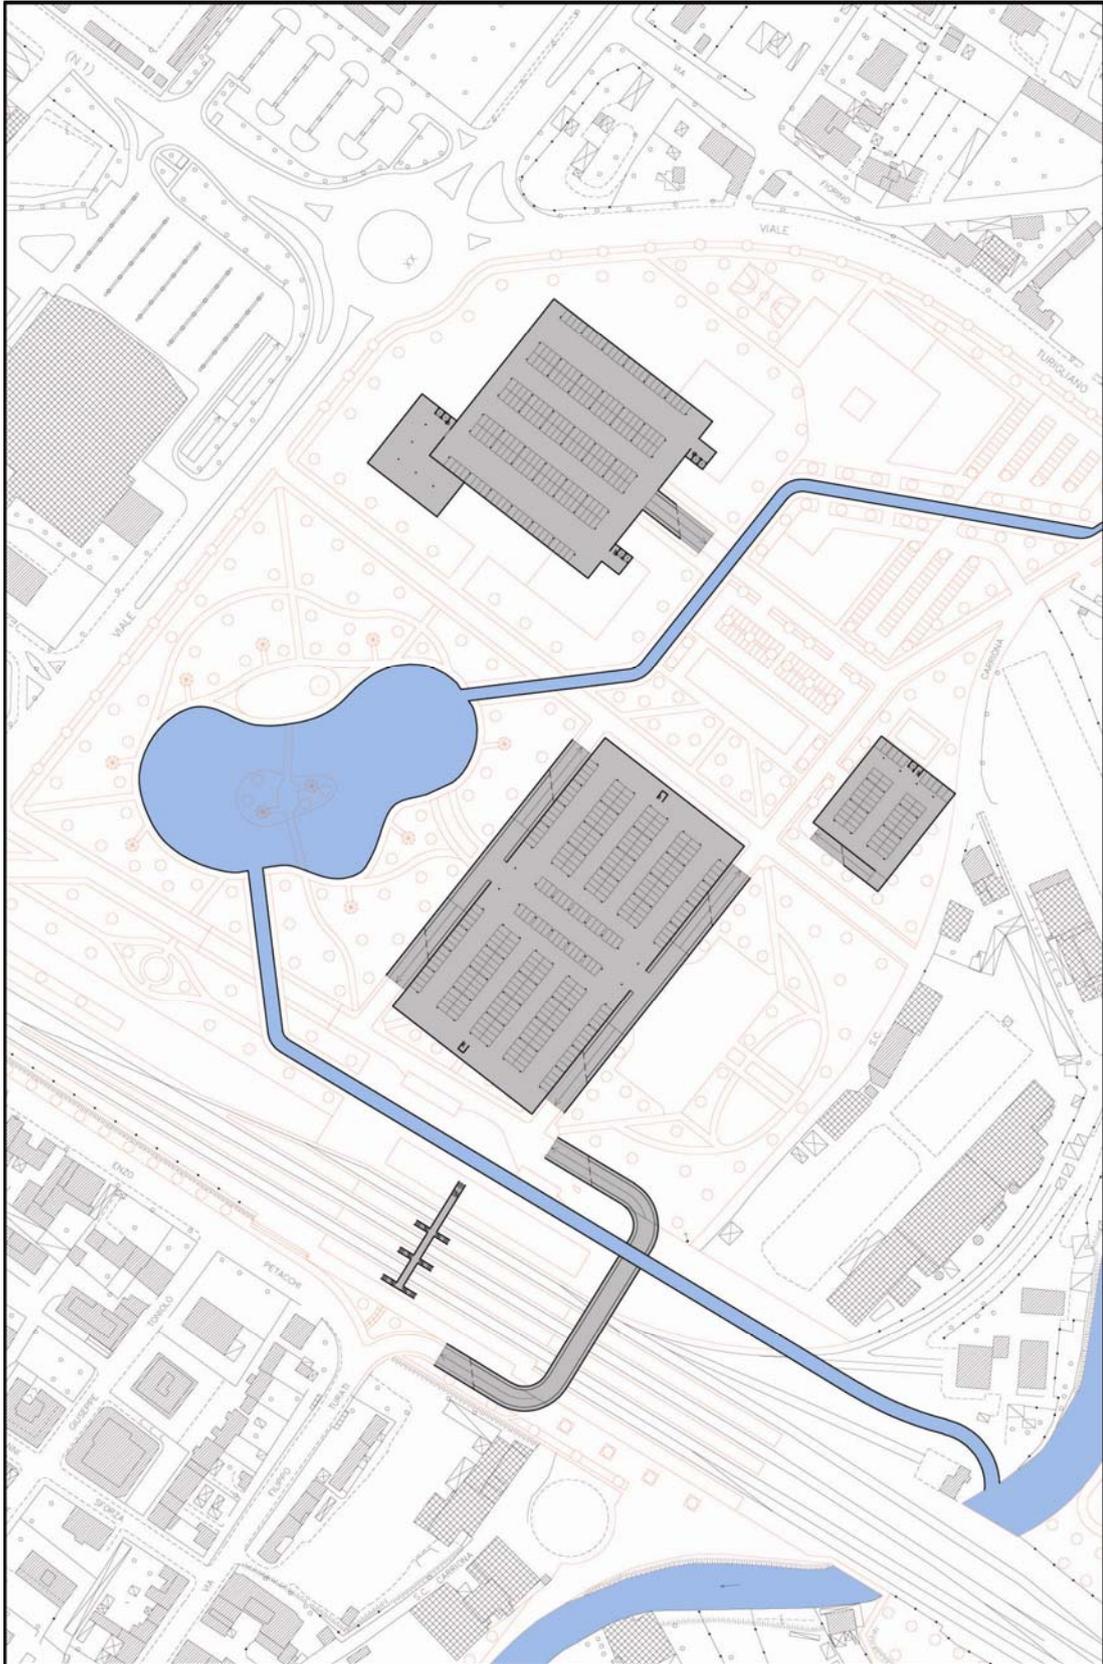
Pianta piano terreno. Ingrandimento
